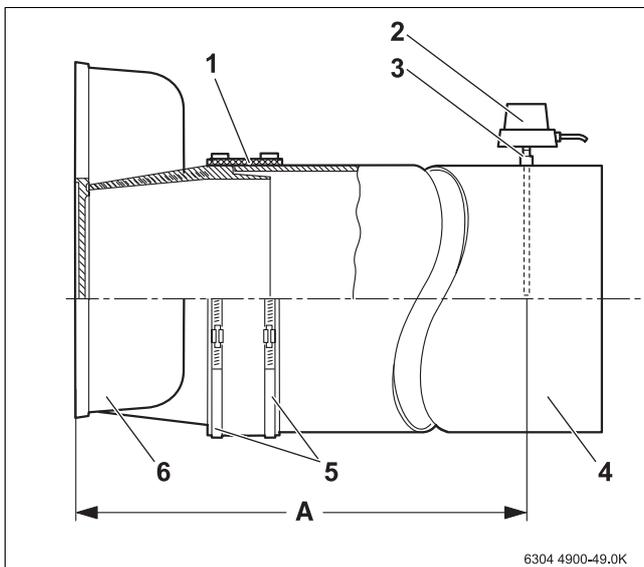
Montaggio del manicotto di tenuta del tubo fumi
